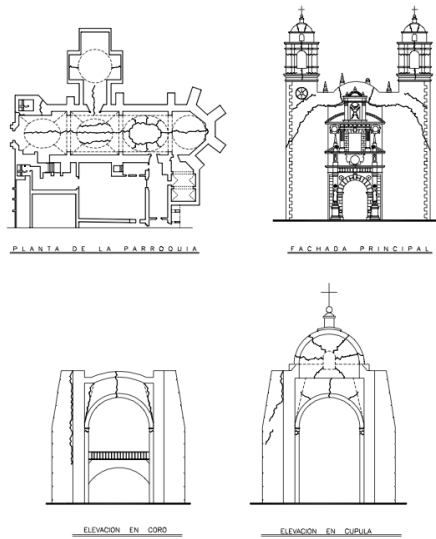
Revisión del patrón de agrietamiento y fisuras en elementos estructurales
